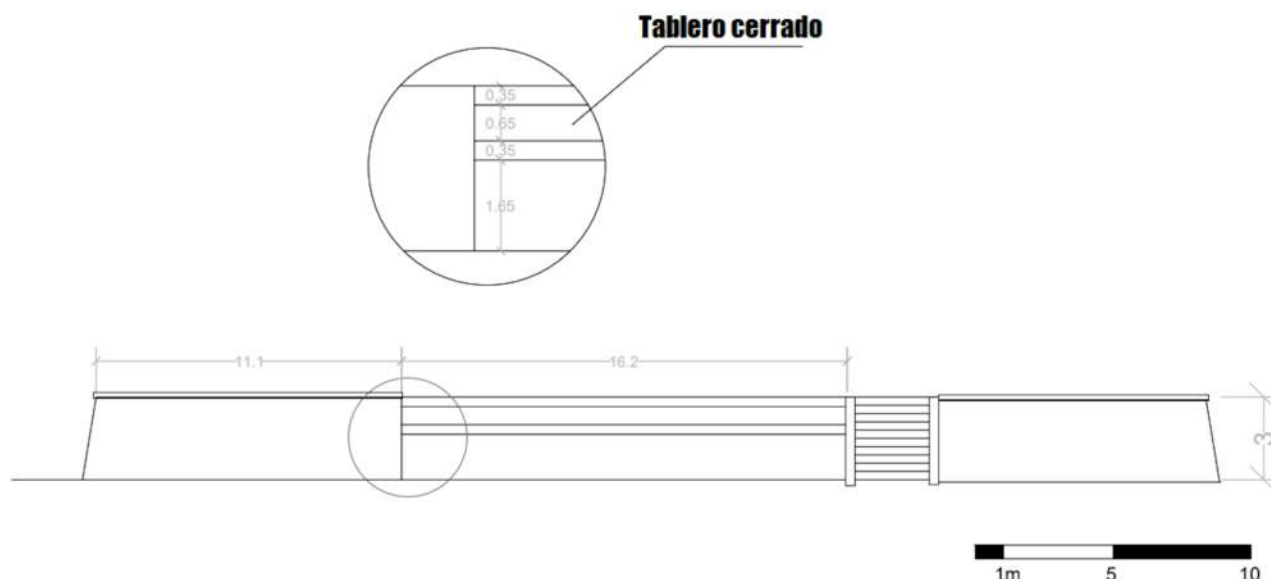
Alzado de la segunda etapa constructiva del Ixtépete. Levantamiento parcial en campo de Alfonso González Fernández. Actualizado con datos del autor.
